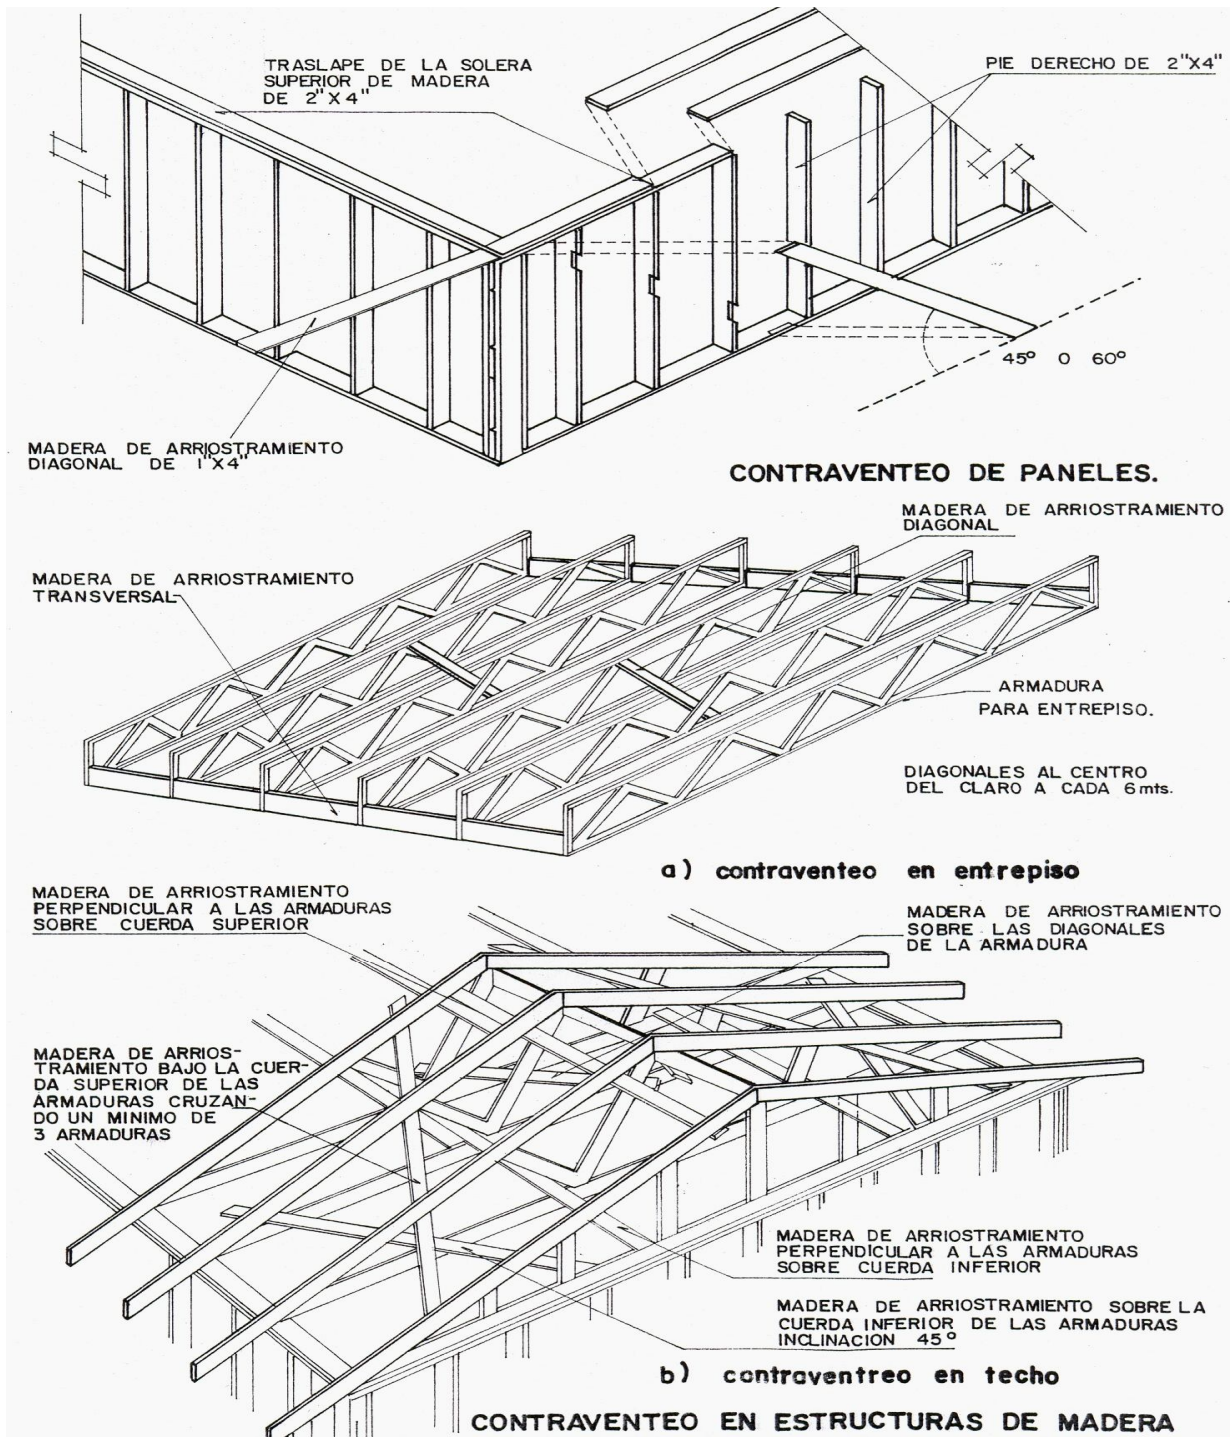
Contraventeo en Paneles y en Estructuras de Madera.
